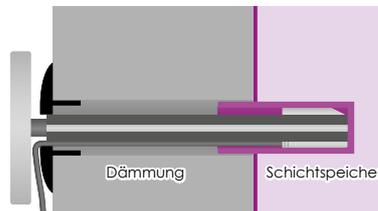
Das Steckmodul ist bis zum Anschlag in die Tauchhülle geschoben.
